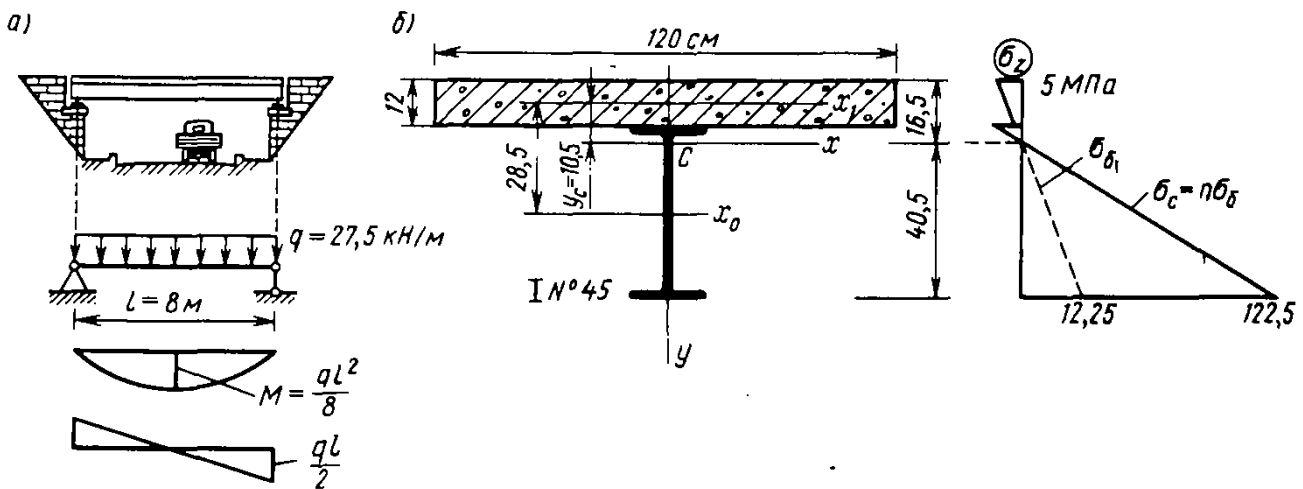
К примеру 6.6. Напряжения в сечении сталежелезобетонной балки путепровода
